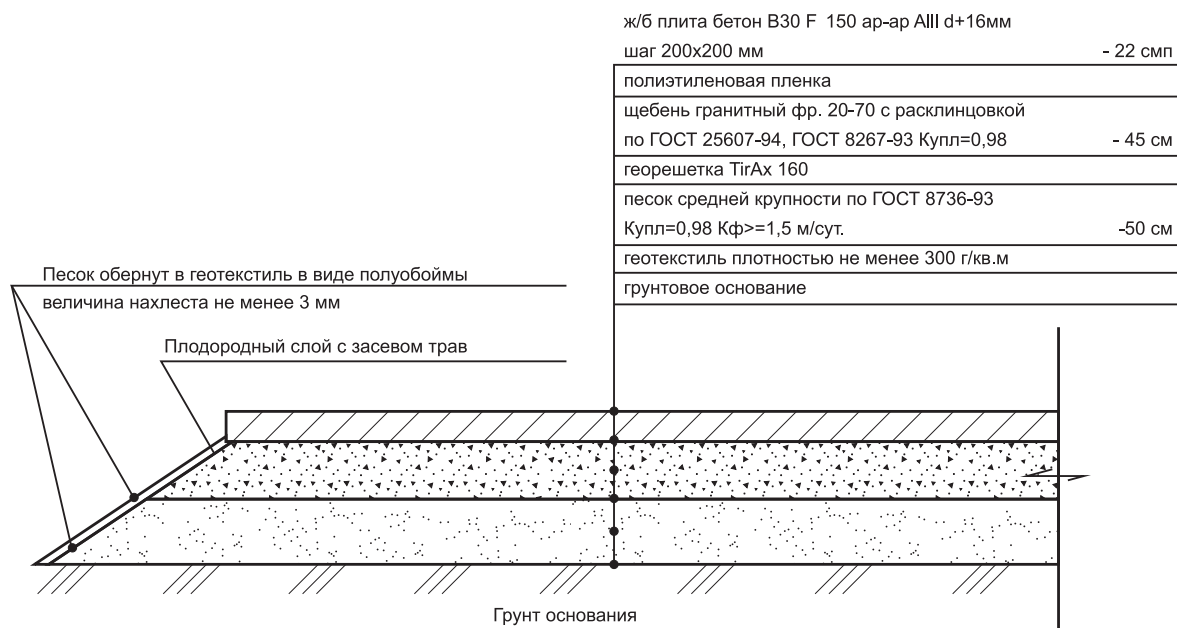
Проектируемое монолитное железобетонное покрытие.
